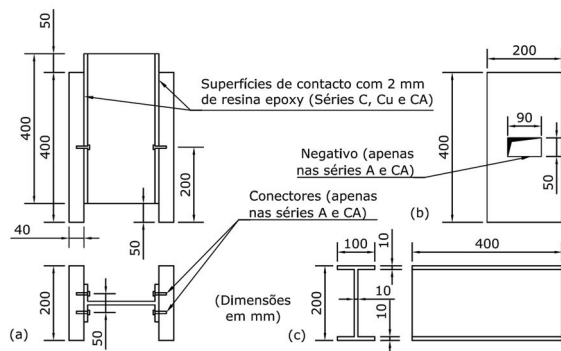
Dimensões: a) dos provetes; b) da lajeta de SFRSCC e; c) dos perfis de GFRP [38].
